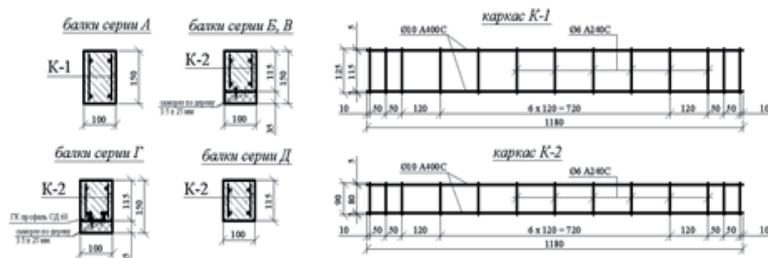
Поперечные сечения и армирование опытных балок серий А-Д.
